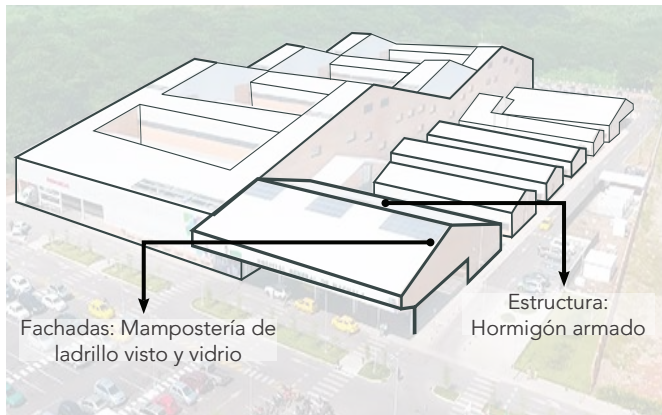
D02 - Detalle Interpretativo de Fachada y Aislamiento Térmico basado en Hospital General de Machala.
